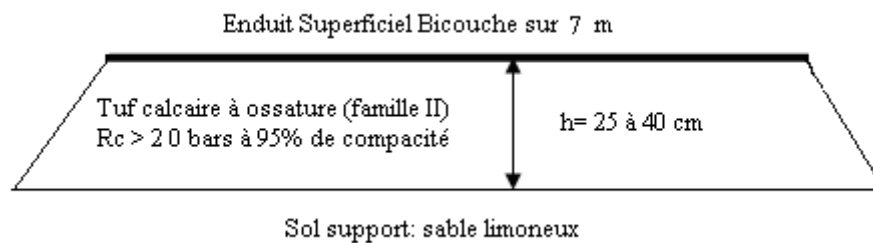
Profil en travers de la chaussée de la RN6 (Larabi, 1998)
